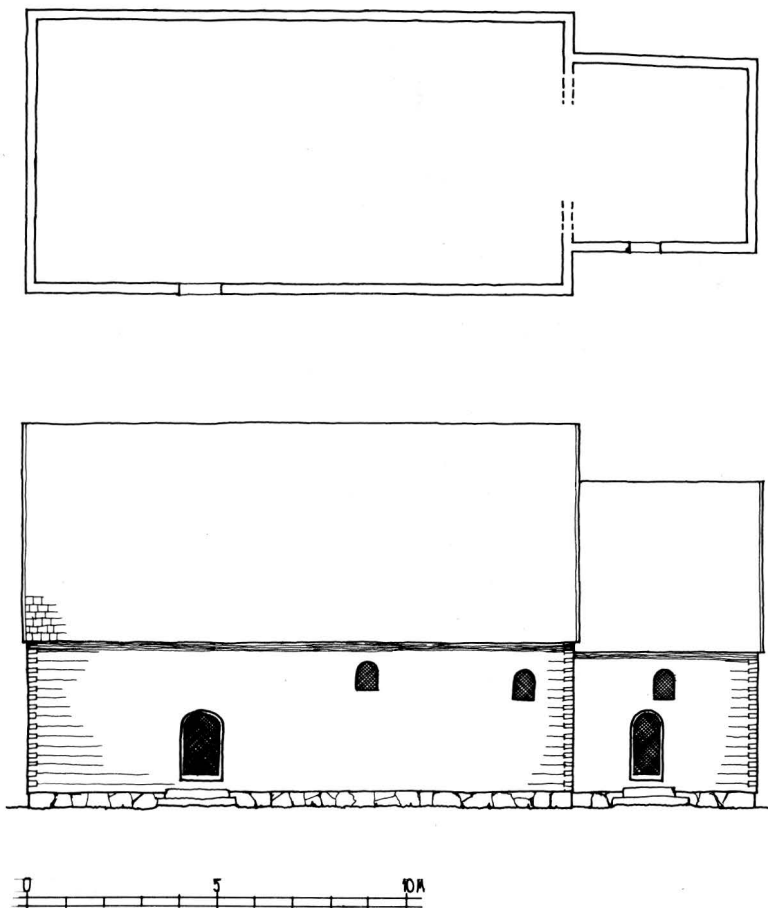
a–b. Den medeltida kyrkans plan och sydfasad, 1 : 200. M Ullén och G Wirén 1982.
